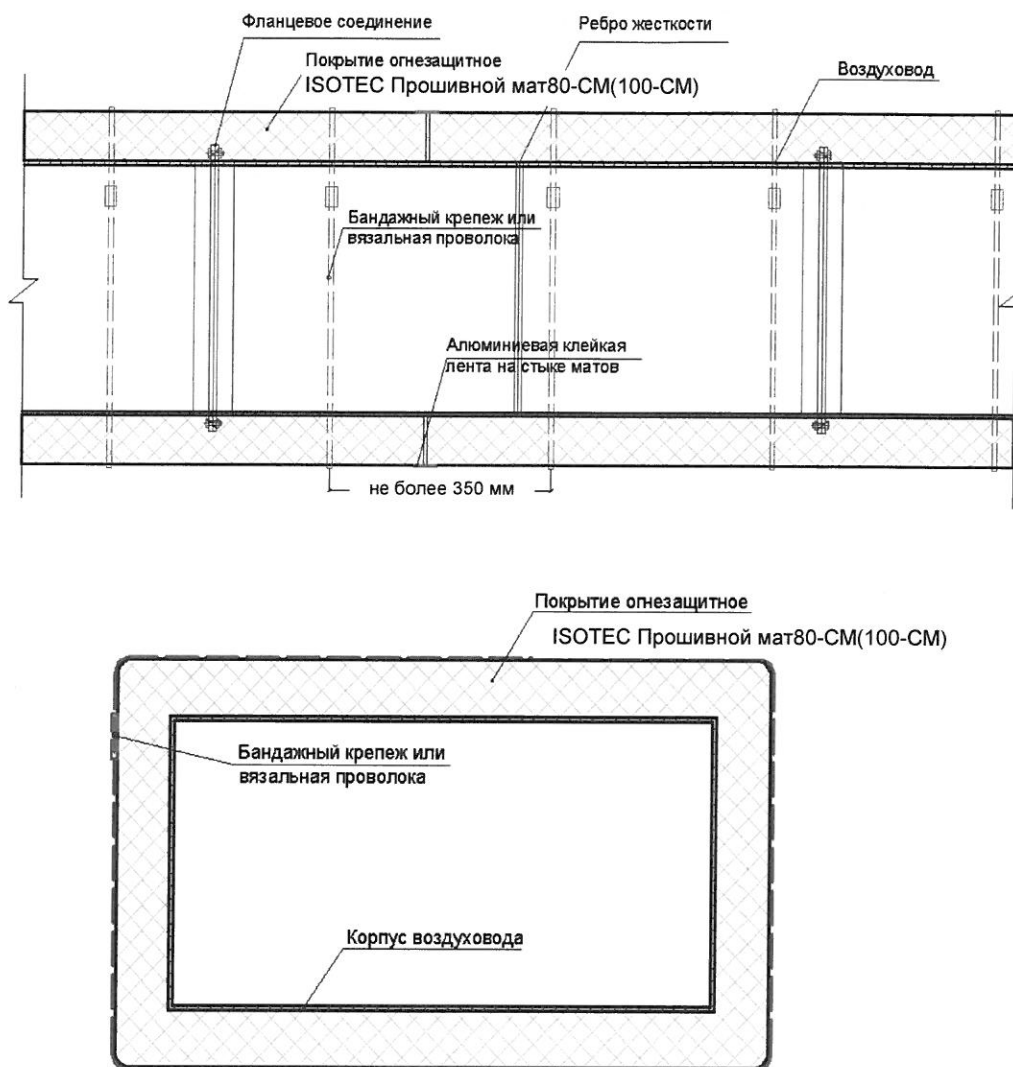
Крепление огнезащитного покрытия ISOTEC Прошивной мат80-СМ, ISOTEC Прошивной мат100-СМ к воздуховоду с помощью бандажного крепежа совместно с вязальной проволокой
